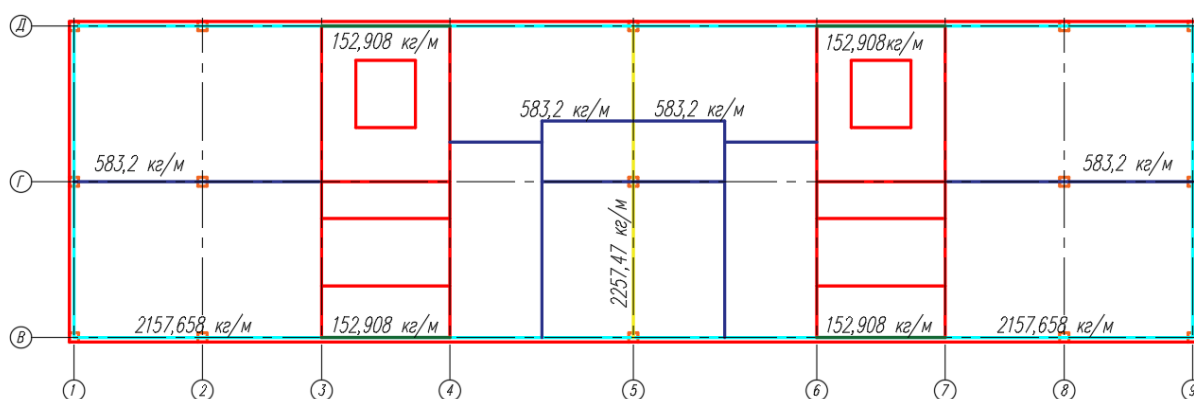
Схема приложения нагрузок от стен и перегородок, кг/м
